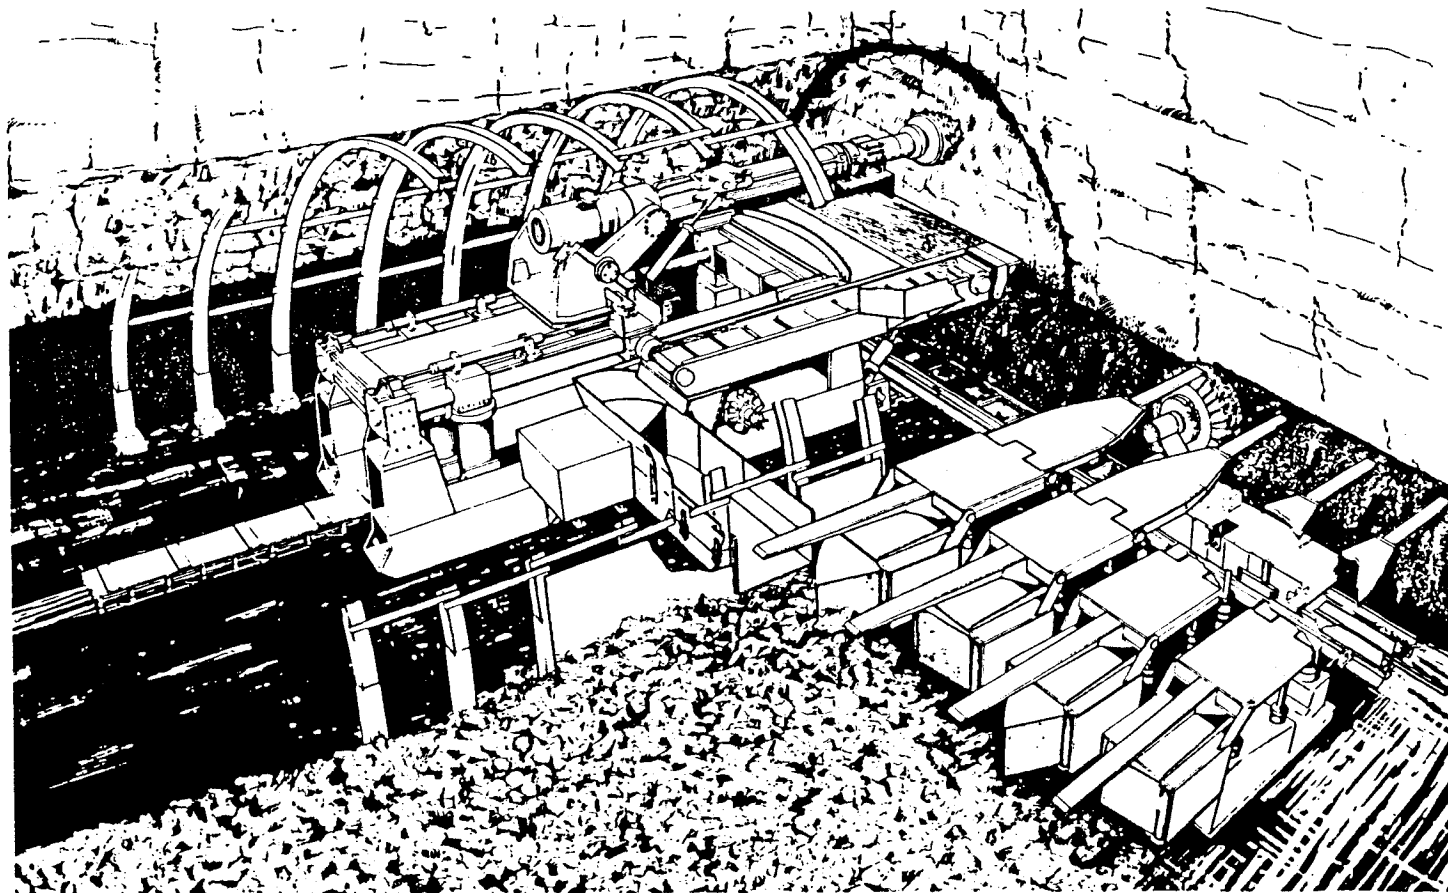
PERSPECTIVA DEL SISTEMA MECANIZADO PARA LA CONSTRUCCION
